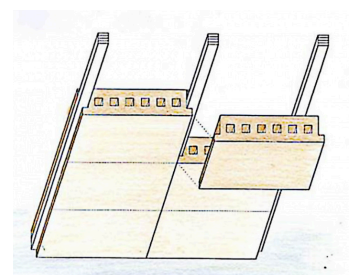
Sistema de unión pilares de madera y bloques prefabricados perforados.
